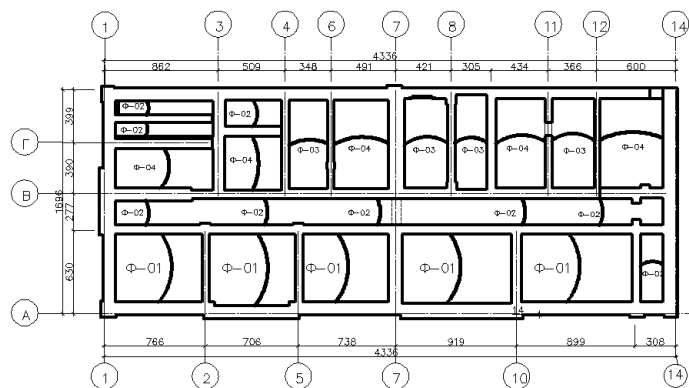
Общая схема здания и схема расположения оболочек в пролетных частях ленточных фундаментов
